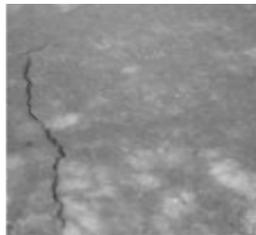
Grietas de borde en la Calle 38, Cristo Rey. Fuente: Elaboración propia.
